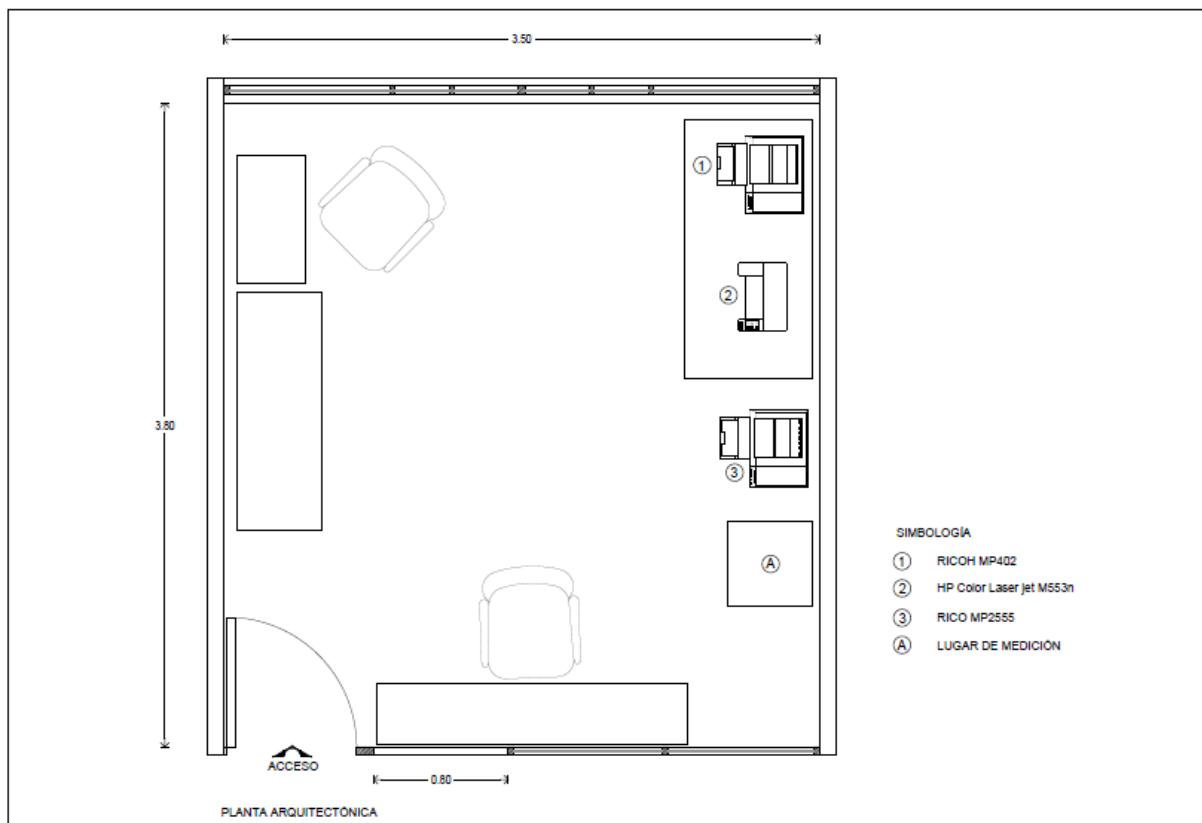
Planta arquitectónica del centro de fotocopiado
